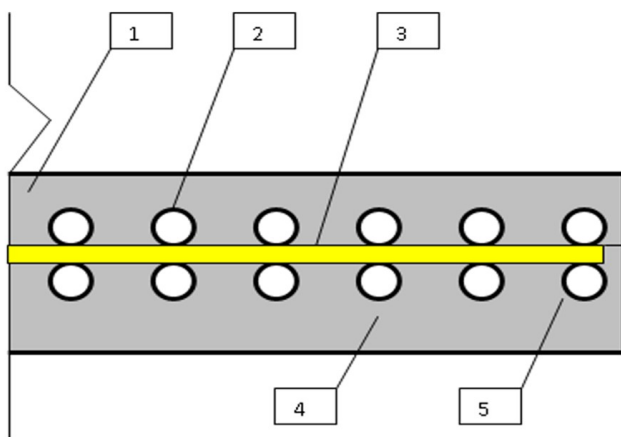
Фрагмент модуля поверхностного фундамента: 1 – верхняя часть железобетонной плиты; 2 – змеевик греющего контура теплового насоса; 3 – теплоизолятор; 4 – нижняя часть железобетонной плиты; 5 – змеевик охлаждающего контура теплового насоса [\[17\]](#)
